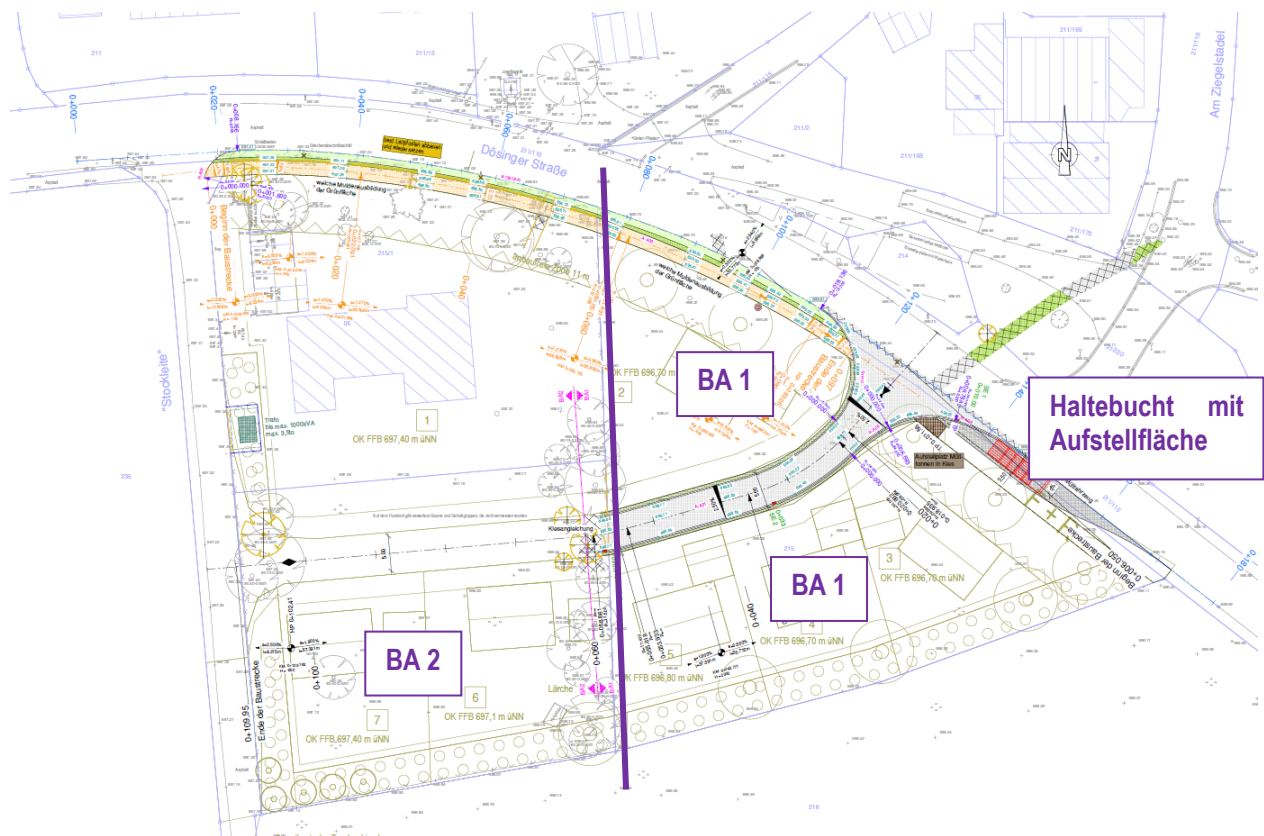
Projektlageplan Haltebucht mit Aufstellfläche, mooser Ingenieure, 21. August 2026, ergänzt D+H
